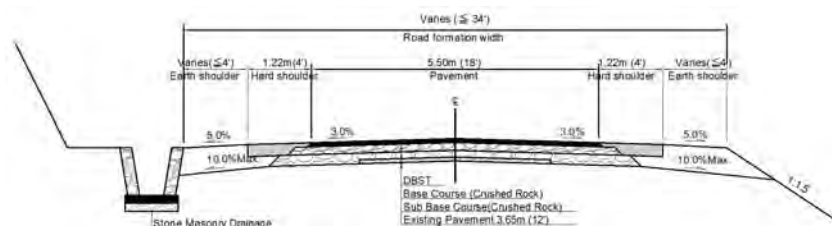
標準横断面図 (山岳部 / MOC-22 : DBST オーバーレイ 5.5m)
